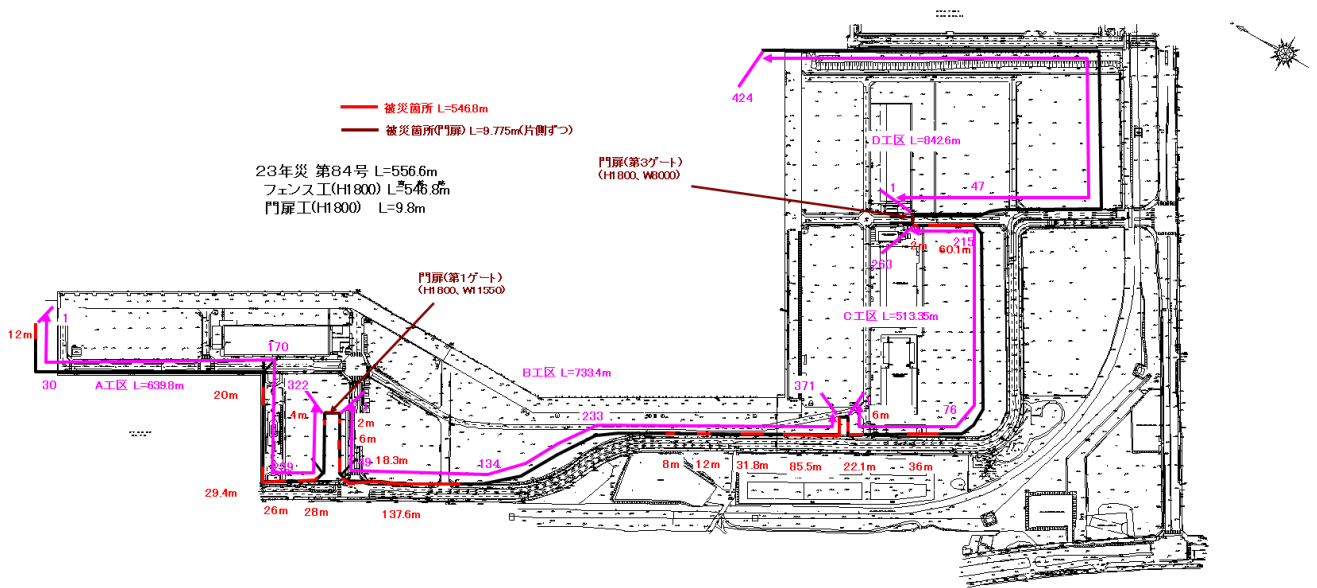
186 No. 1 南公共埠頭フェンスの平面図 (被災後)
